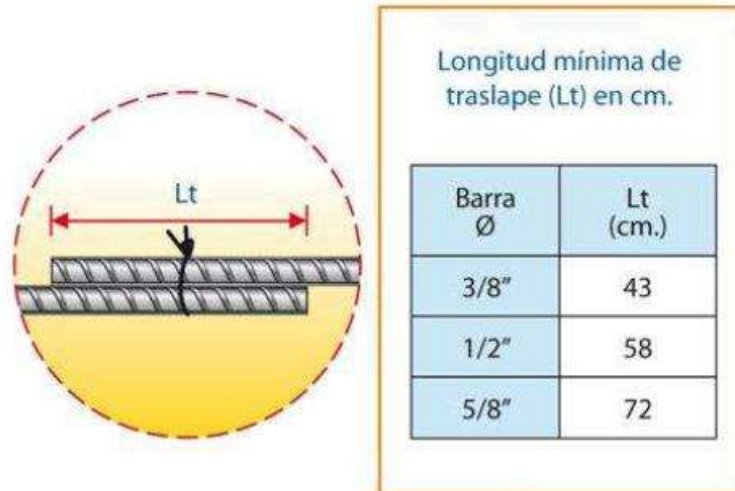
IMAGEN V – UNIONES ENTRE VARILLAS – (ACERO DE REFUERZO)
